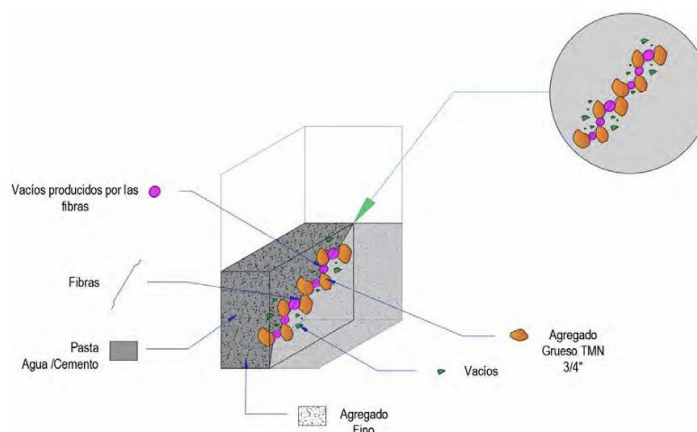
Estructura de concreto permeable con incorporación de fibras. Fuente: [55].
